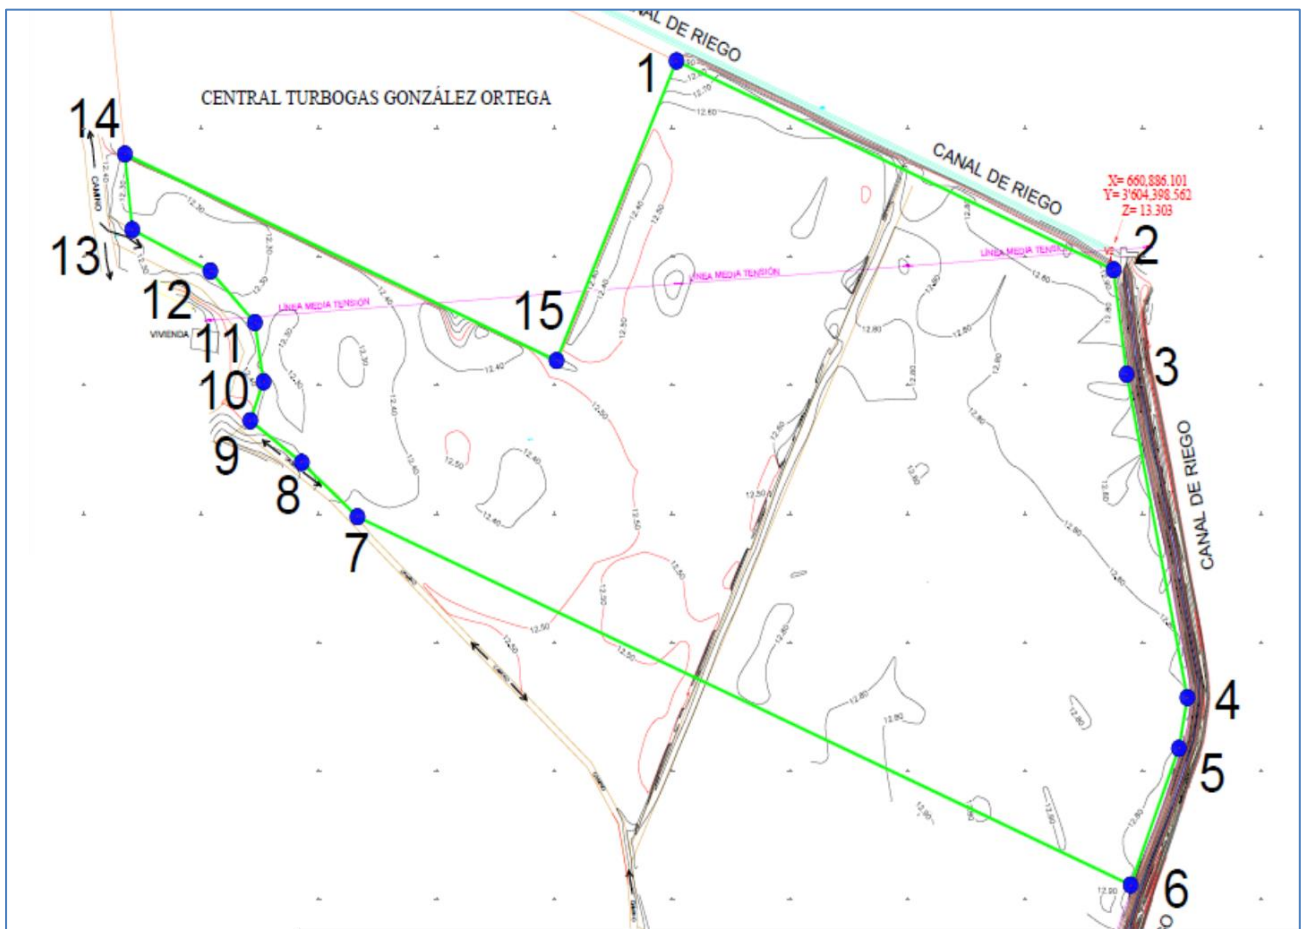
Predio donde se instalará el proyecto (Plano 1)
